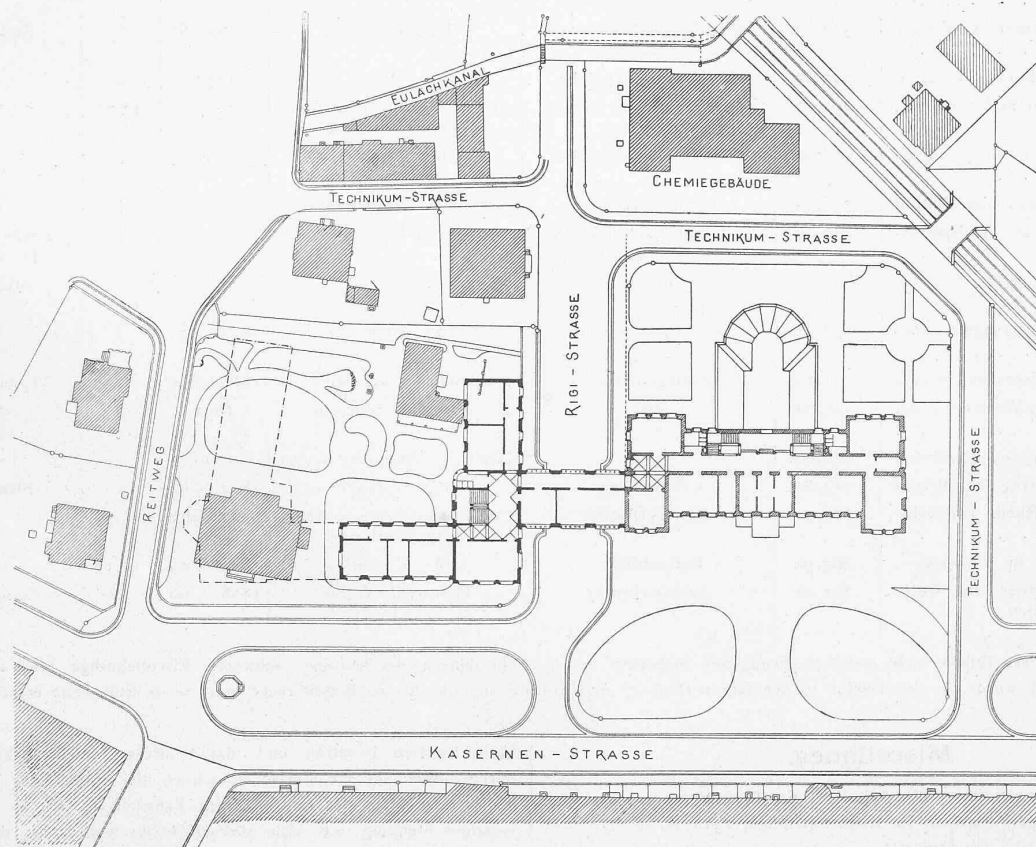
Lageplan und Grundriss vom Obergeschoss. — Masstab 1:1500.
